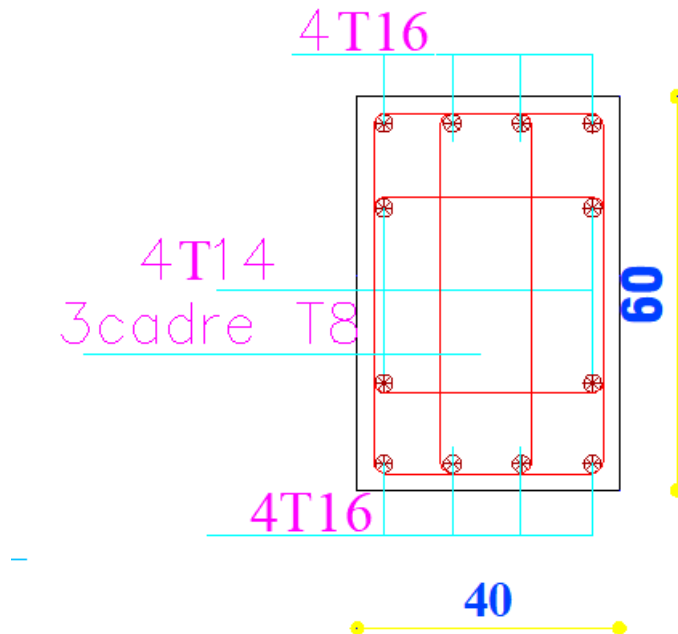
Ferrailage des poteaux (RDC et Etage).
